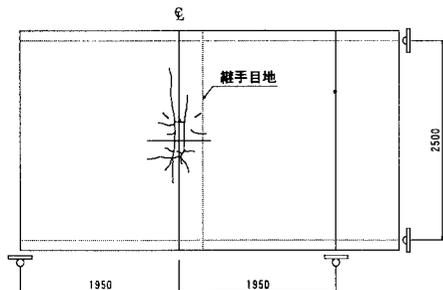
定荷重疲労試験終了時における床版下面のひび割れ状況
